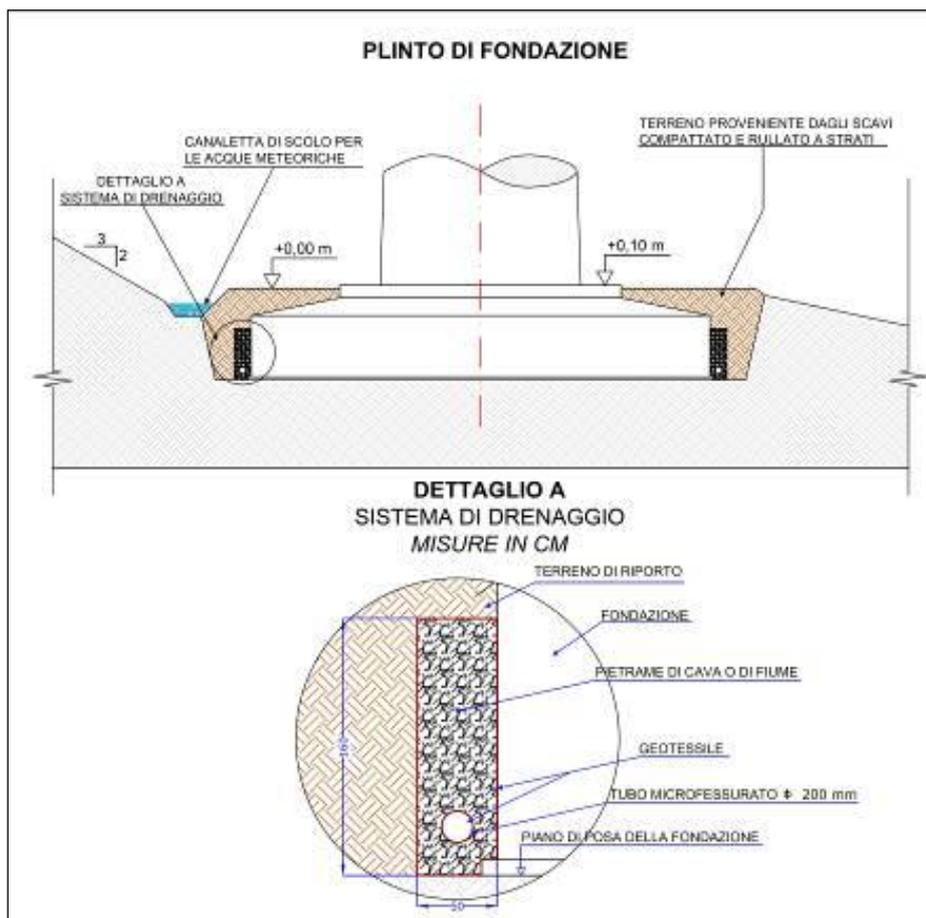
Sistema di drenaggio ai piedi della piazzola e alla base del plinto fondazionale
